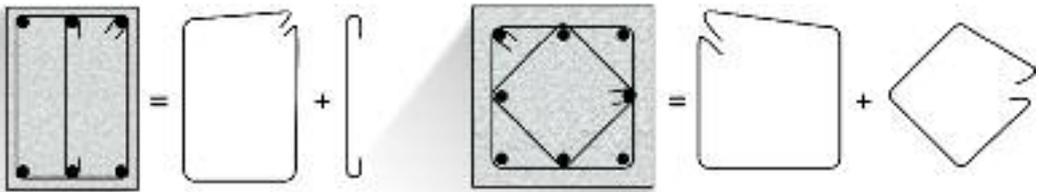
Maintien individuel des barres des poutres et des poteaux par des armatures transversales
